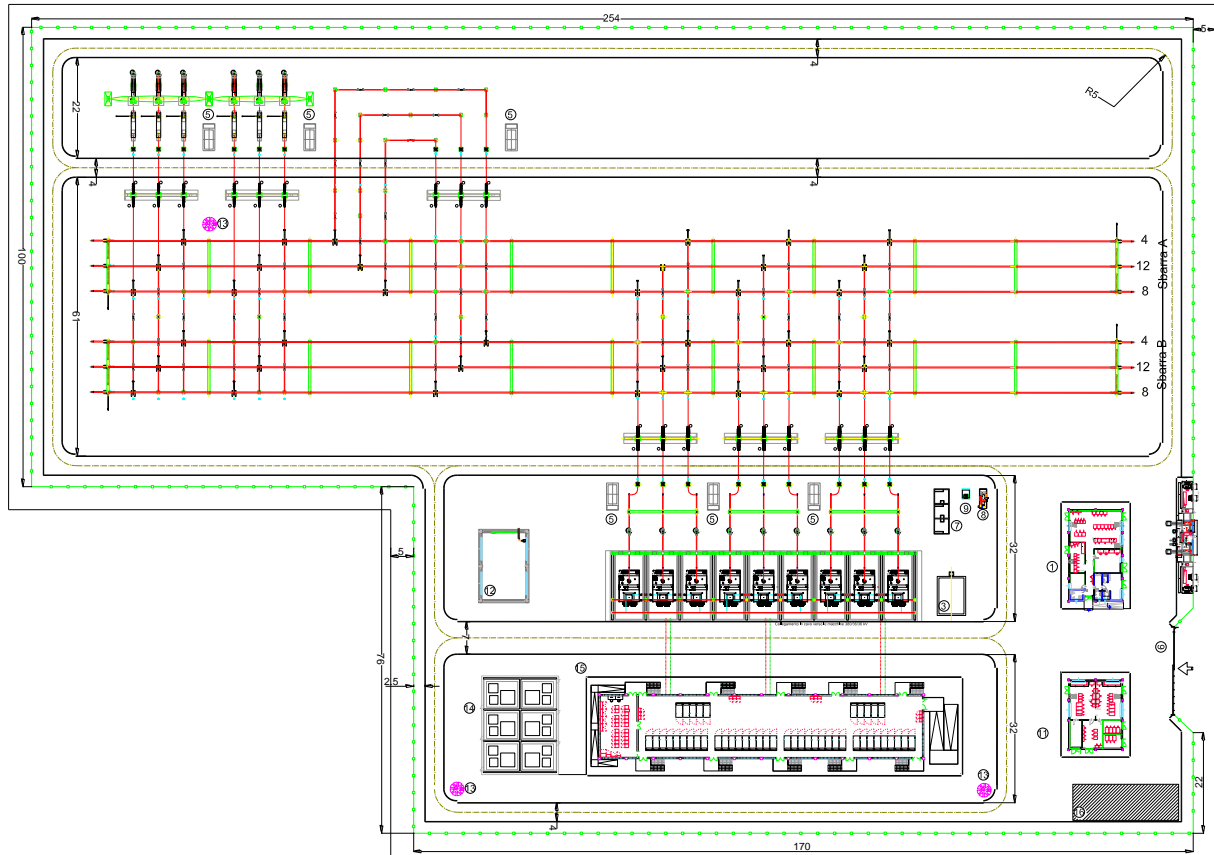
PLANIMETRIA ELETTROMECCANICA GENERALE
